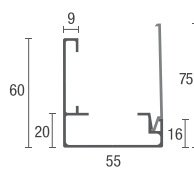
DETAIL UPEVNĚNÍ SPOJOVACÍHO PROFILU
